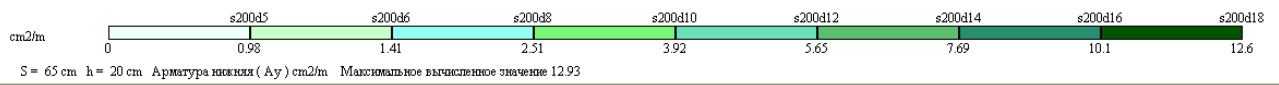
Площа арматури на 1 м. п. по осі Y нижньої грані
